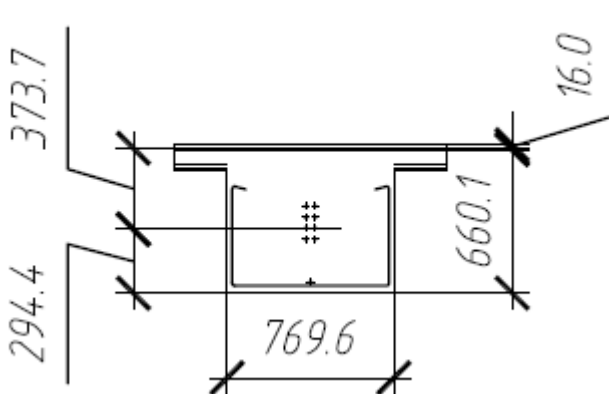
Схема сечения плиты перекрытия «Чайка»
